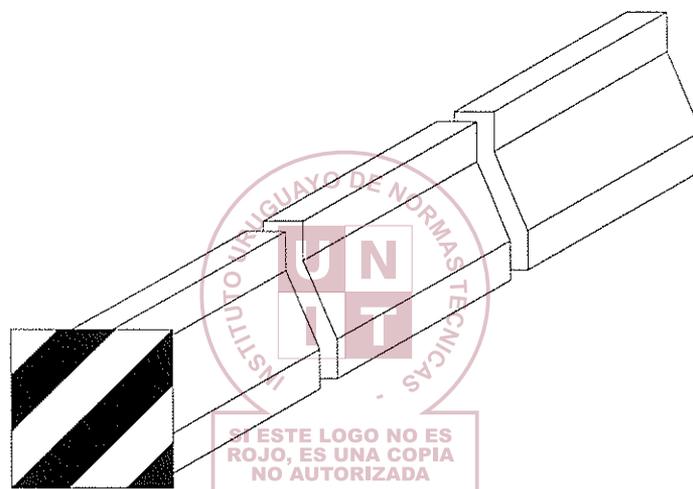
Barrera tipo New Jersey con la placa de advertencia
